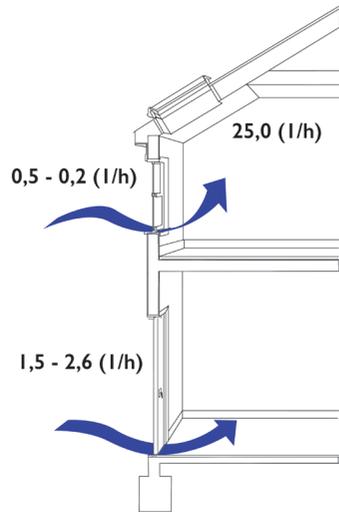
Infiltración de aire en ventanas y puertas en viviendas de hormigón armado.
